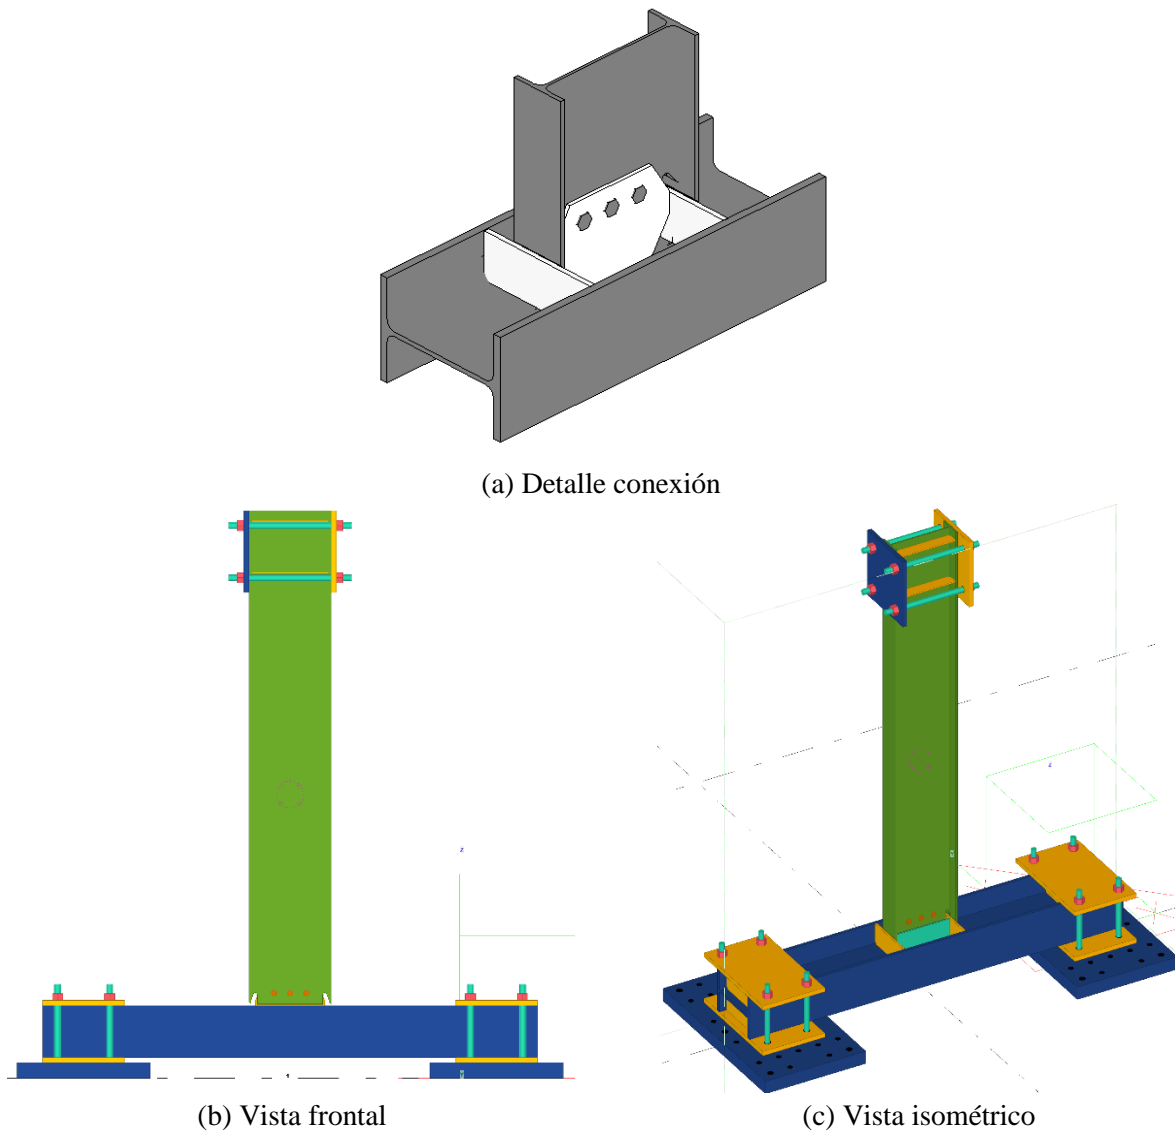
Prototipos unión viga-columna sobre eje menor de la columna. Prototipo CTA
